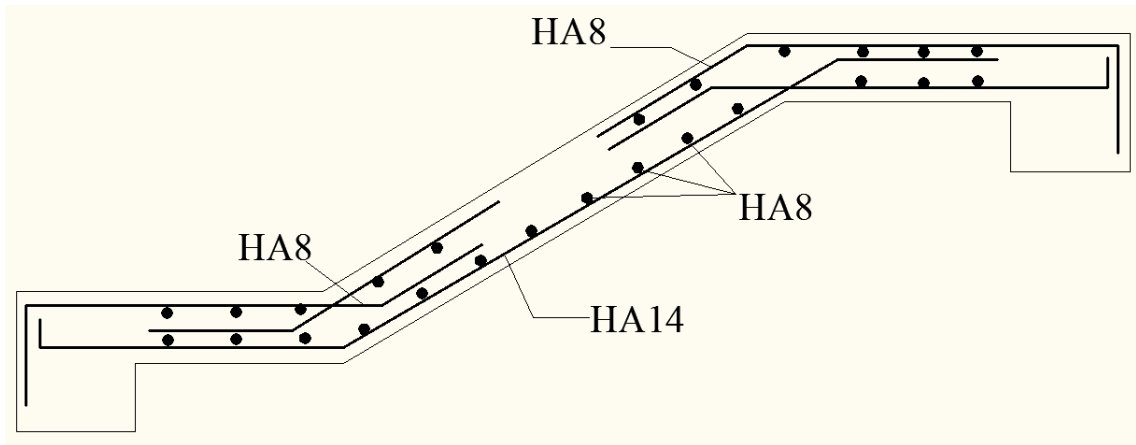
Schéma de ferrailage de l'escalier type 2
